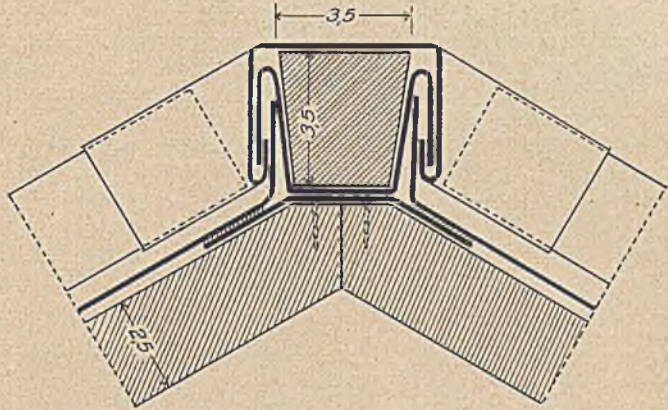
Zinkleistendach. Eindeckung des Firstes.
